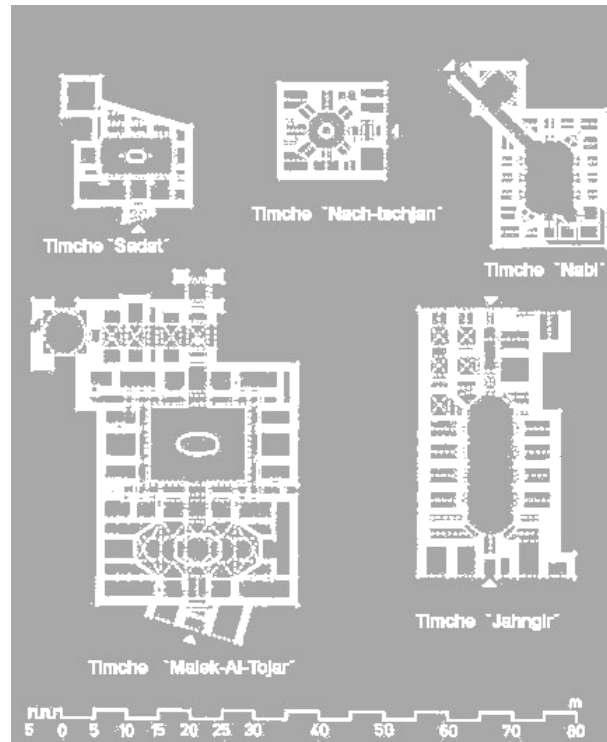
26 Grundrissbeispiele der Timcheanlagen in Isfahan
